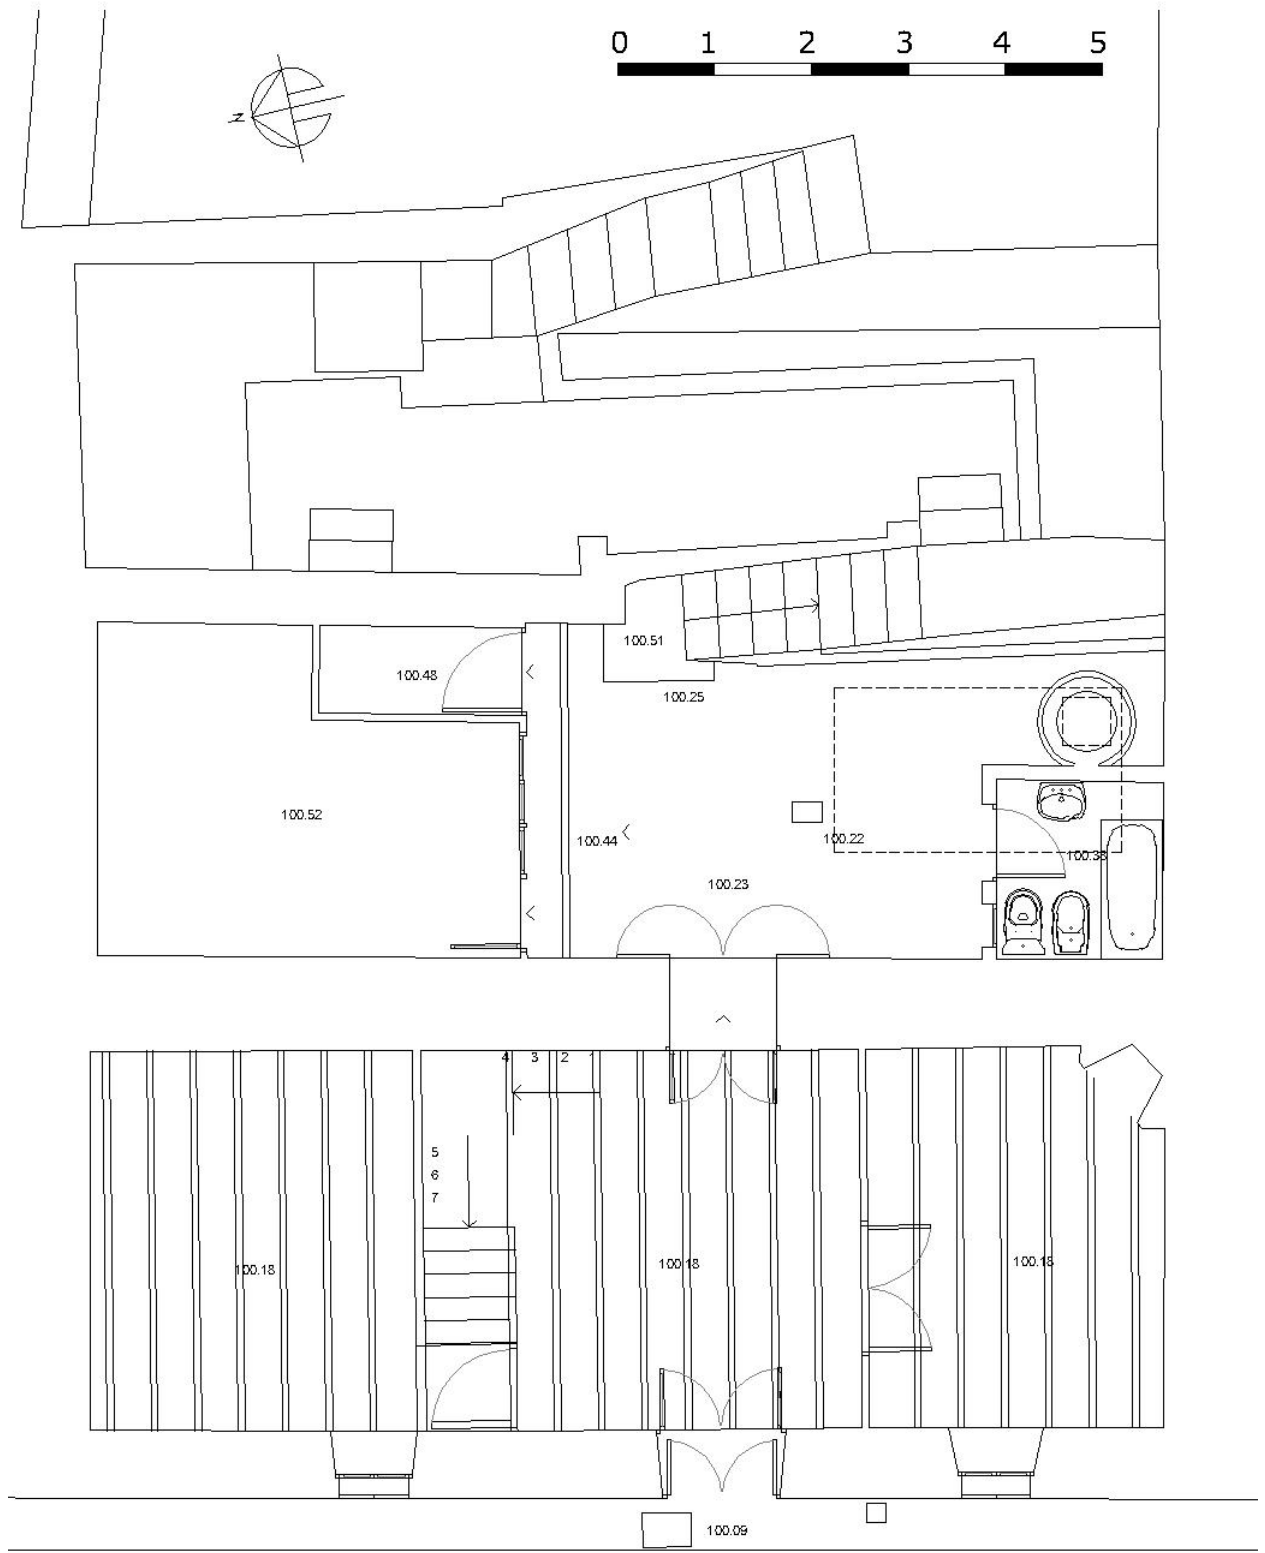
Estado actual de la vivienda sita en calle Llum, 9. Planta baja
